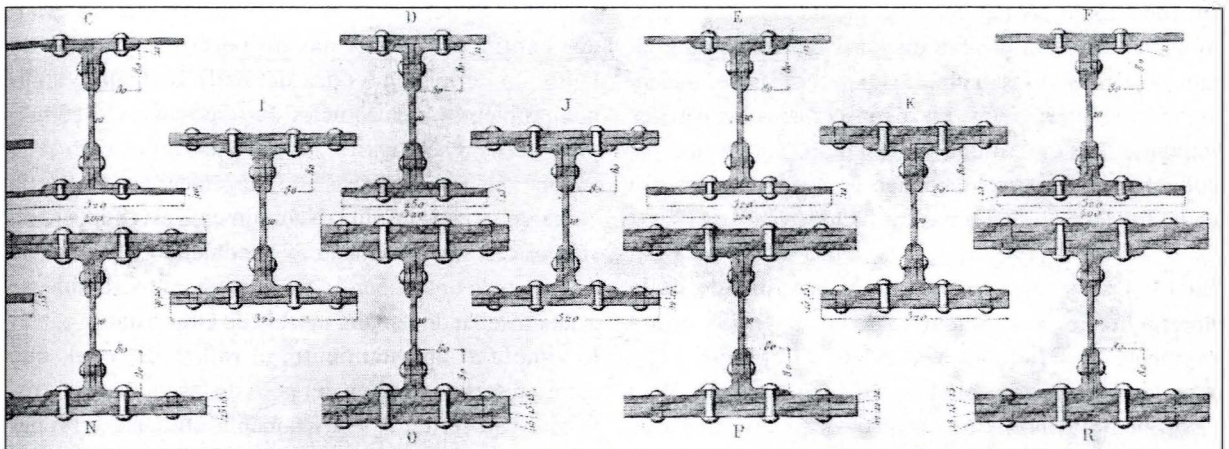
Elementos estructurales fabricados con flejes y ángulos
